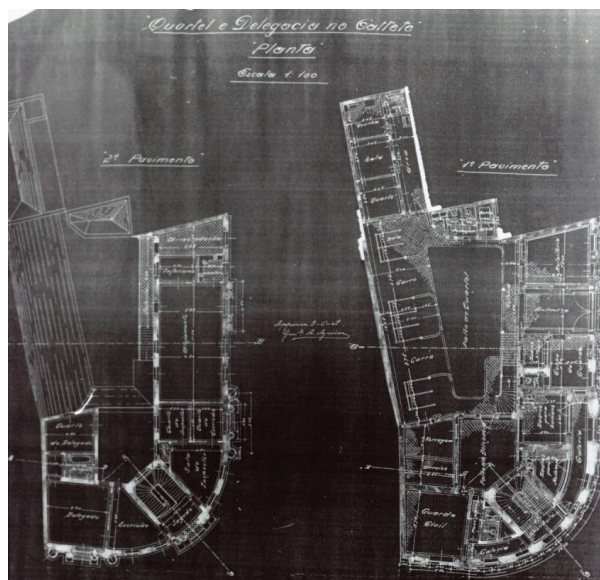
Planta baixa Delegacia do Catete 1º e 2º pavimentos Fonte: Arquivo da CEDAE - RJ
